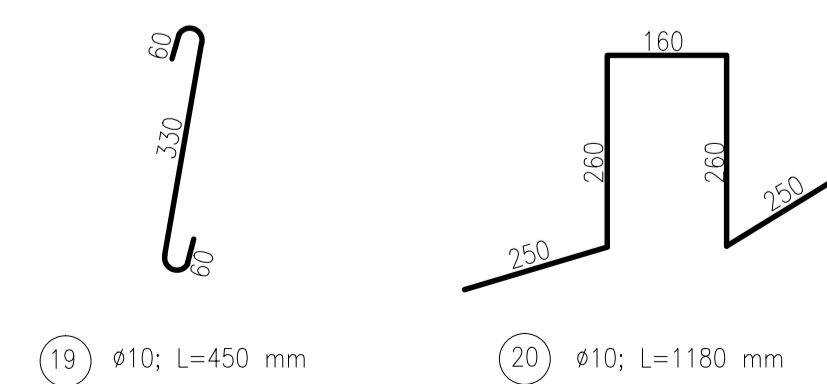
DETAIL ROZMÍSTĚNÍ VÝZTUŽE V DESCE D2 M1:5
